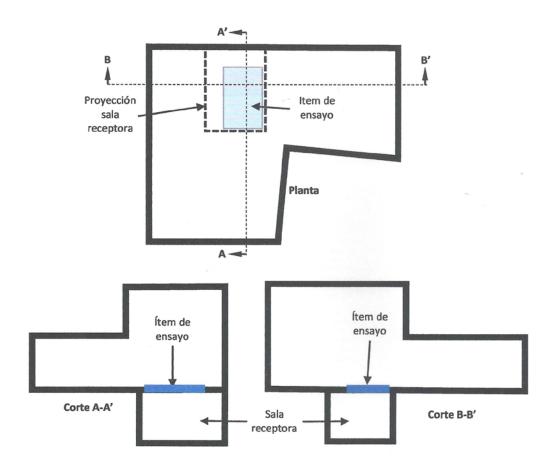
Esquema de planta y corte de los recintos de ensayo
